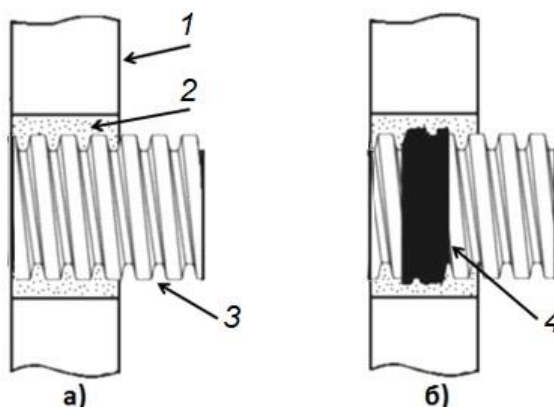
Ввод трубы типа «ССД-Пайп» 125 мм в стену железобетонного колодца: 1 – наружная поверхность стены колодца; 2 – отверстие в стене колодца заполненное строительным (цементно-песчаным) раствором; 3 – выход трубы внутри колодца для надевания наружной заглушки; 4 – труба ССД-Пайп; 5 – кольцевой бандаж из ленточной мастики типов ЛМ или МГ 14-16.
